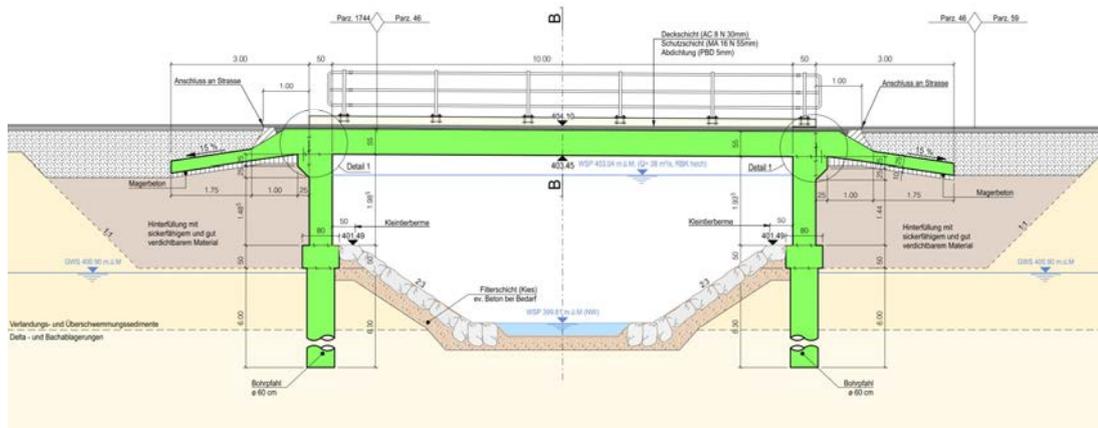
Vertikale Linienführung Brücke Walzenhauserstrasse, Littenbach
